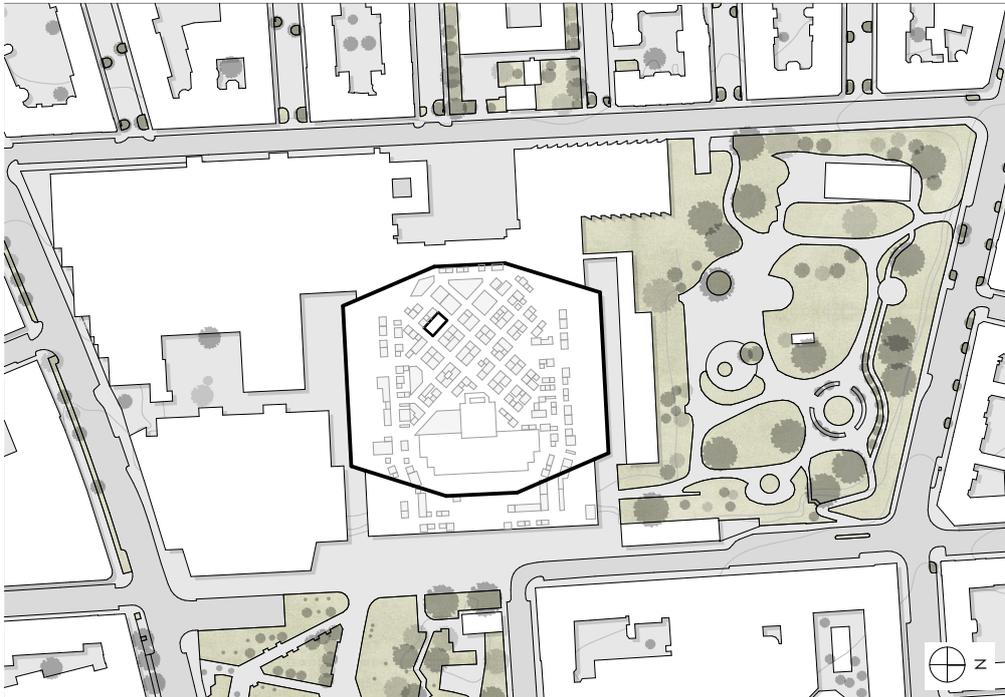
Lageplan Stadthalle [eigene Darstellung]
